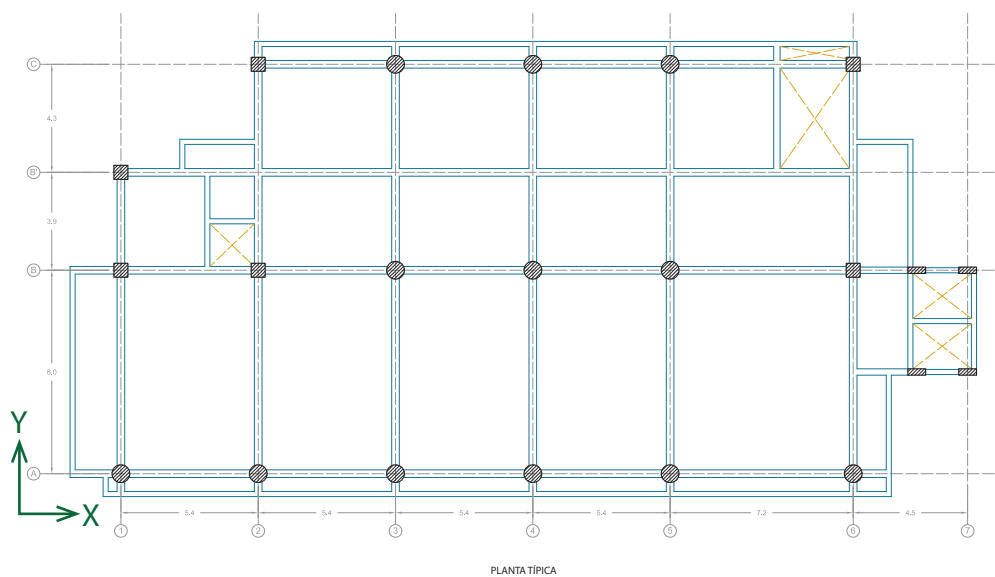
Vista en planta de la edificación del centro de información FIC UNI.
